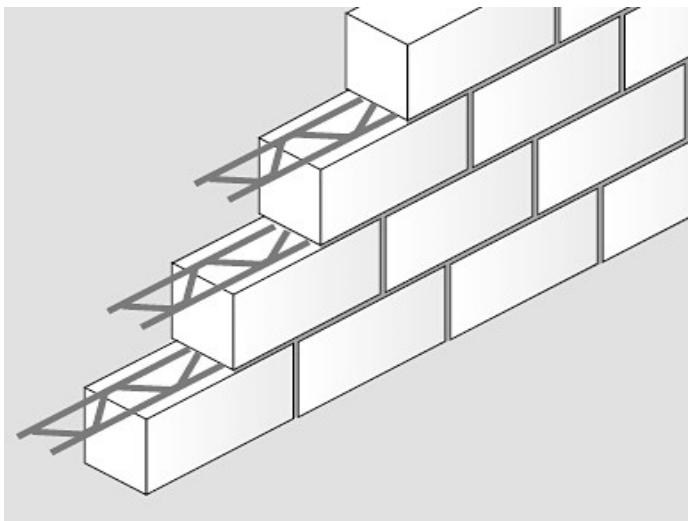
Bewehrtes Mauerwerk (horizontale Bewehrung).
